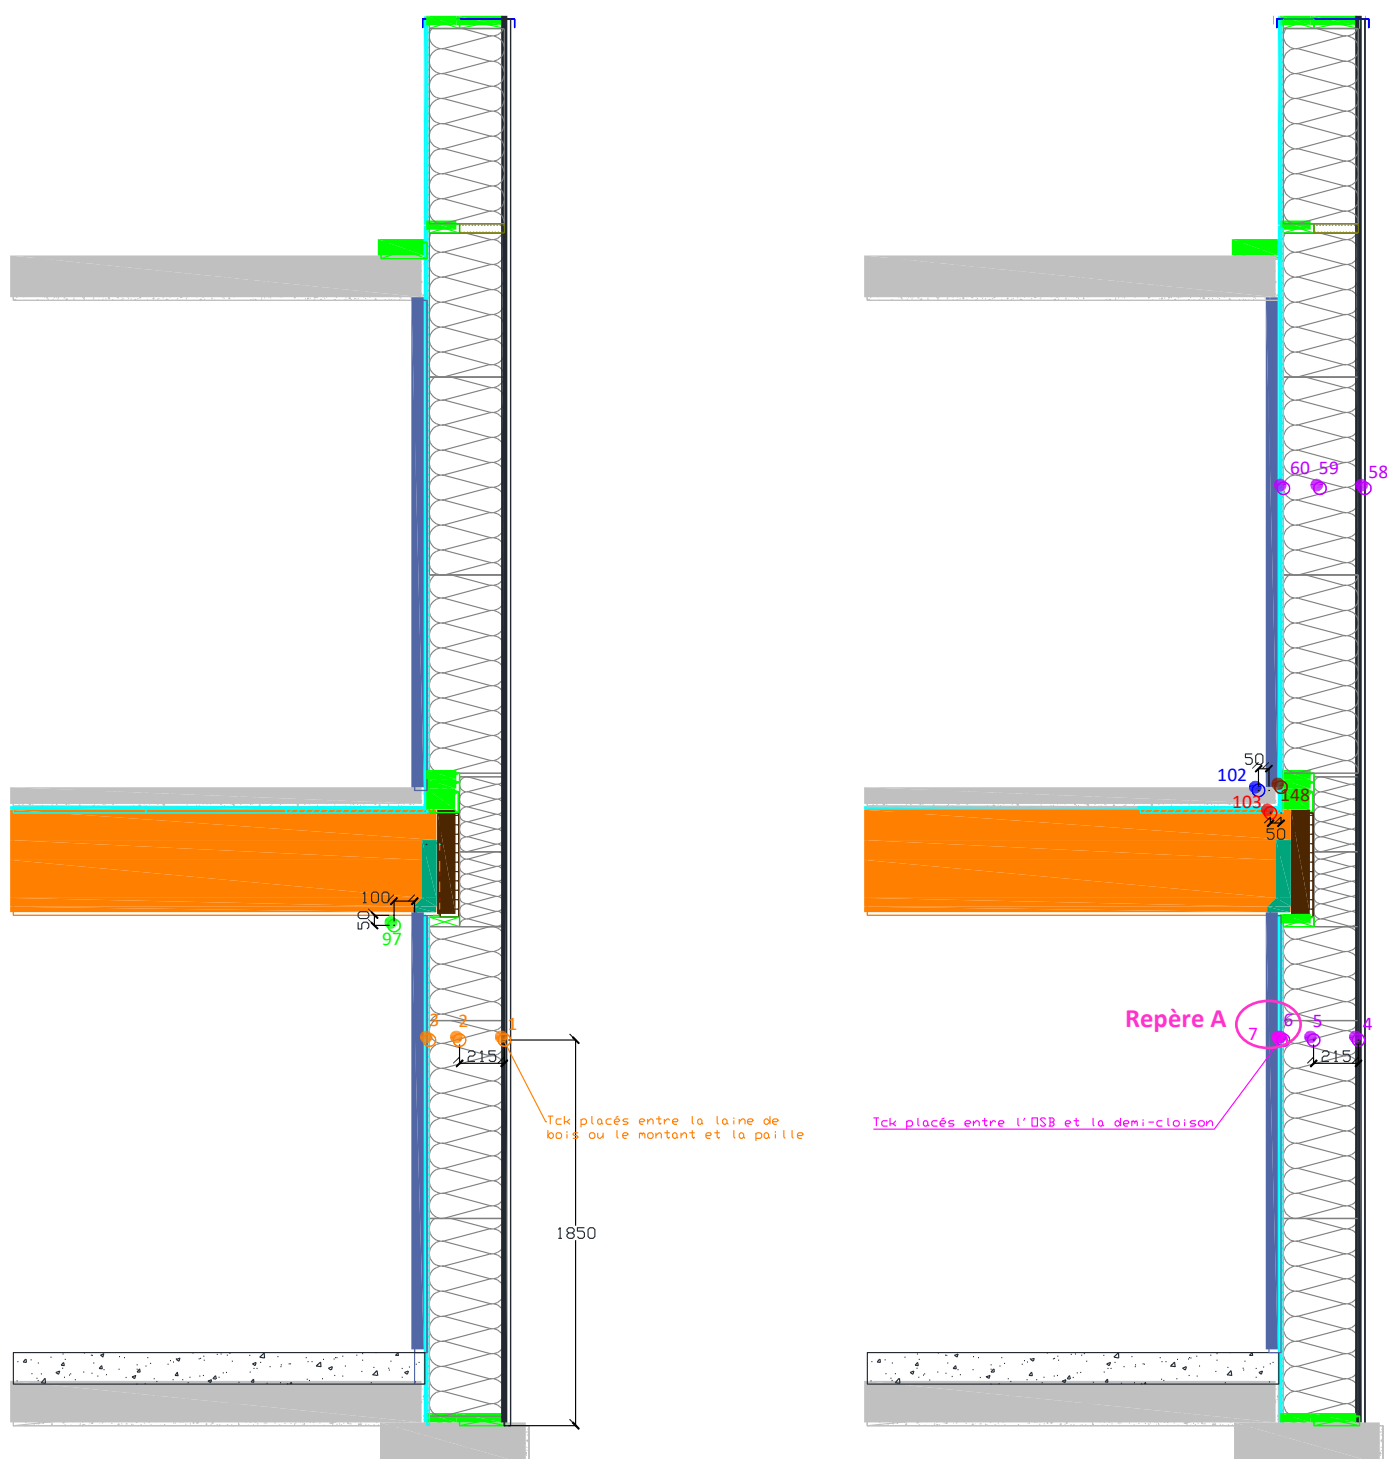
Instrumentation de l'élément de façade - (A gauche) : Coupe A-A - (A droite) : Coupe B-B
